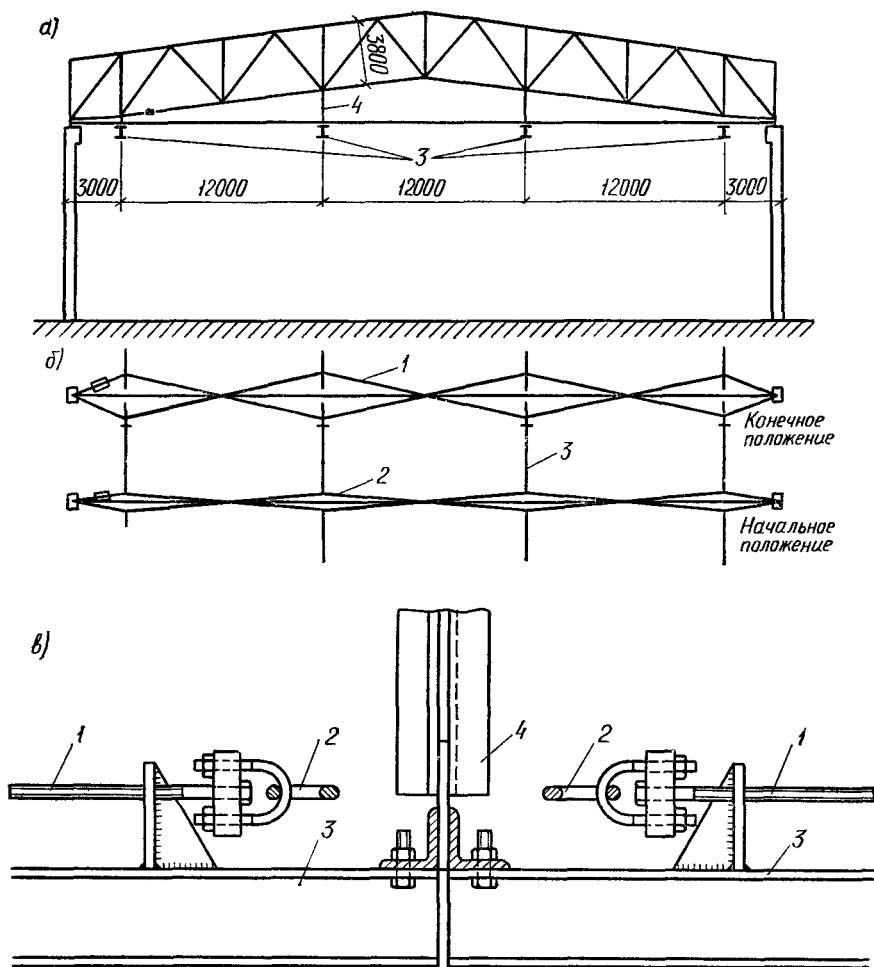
Схема предварительного напряжения ферм покрытия здания и подвесных подкрановых балок петлевыми затяжками
